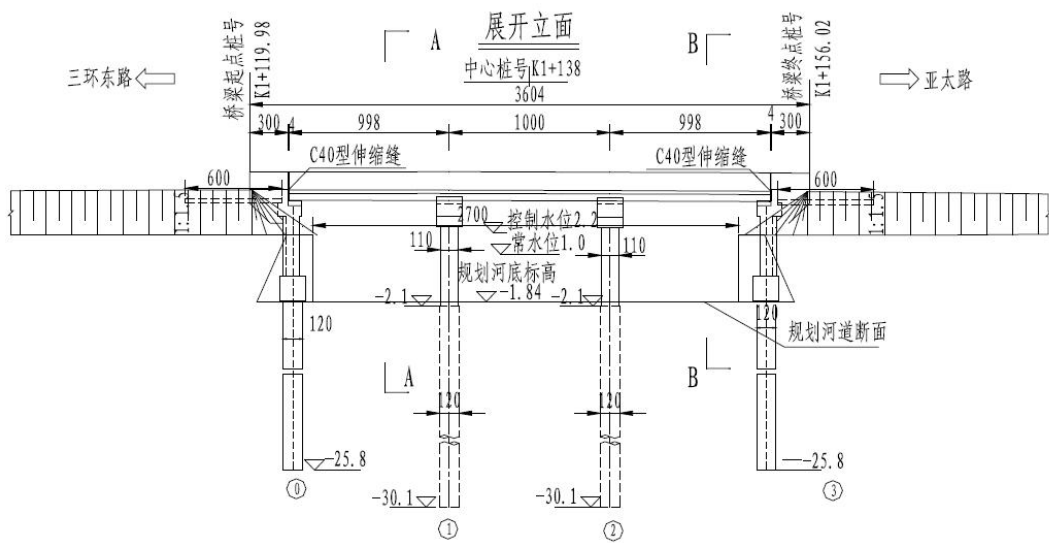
万兴路（三环东路-亚太路）段——桥型立面图
